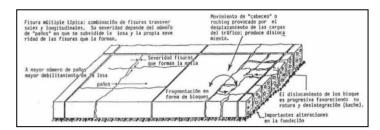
Falla por fisura Múltiple de Pavimento Rígido
